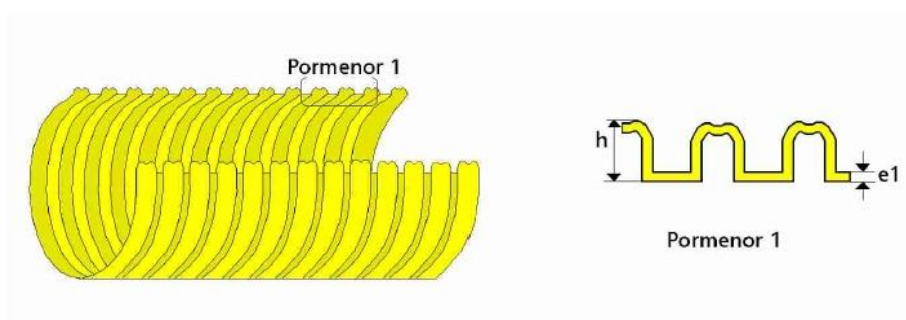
Pormenor Tubo de Drenagem [17]
